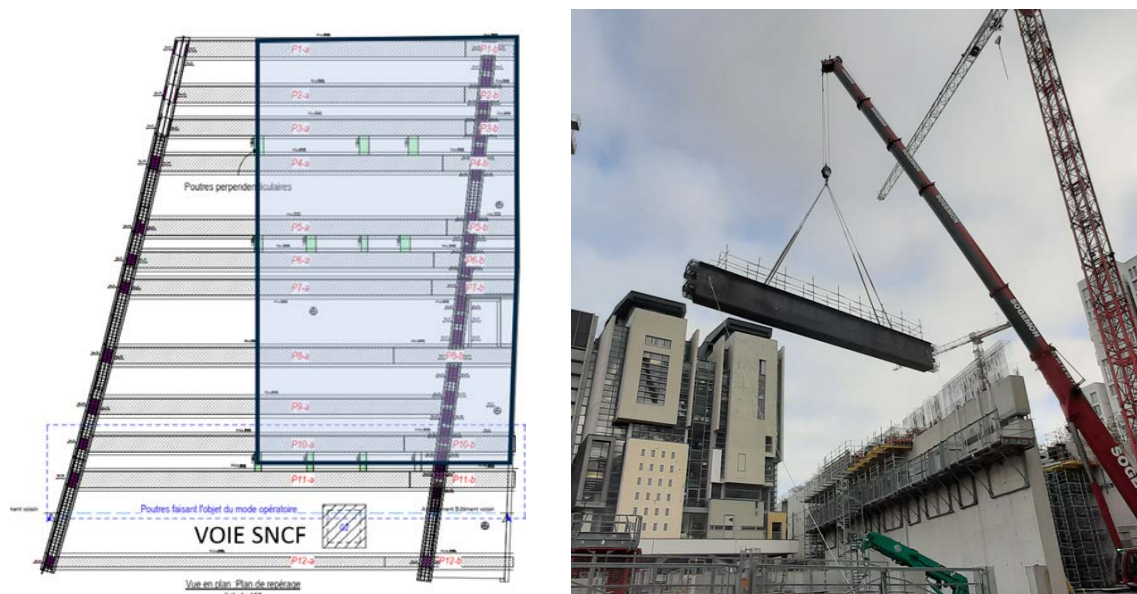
Chantier Algo House, Paris 13 (75) - Plan des poutres et installation à la grue mobile
